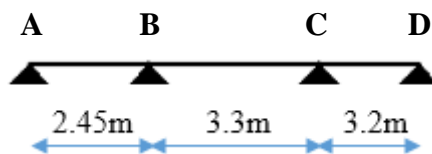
Schéma statique de la poutrelle Type 1 étage courant
